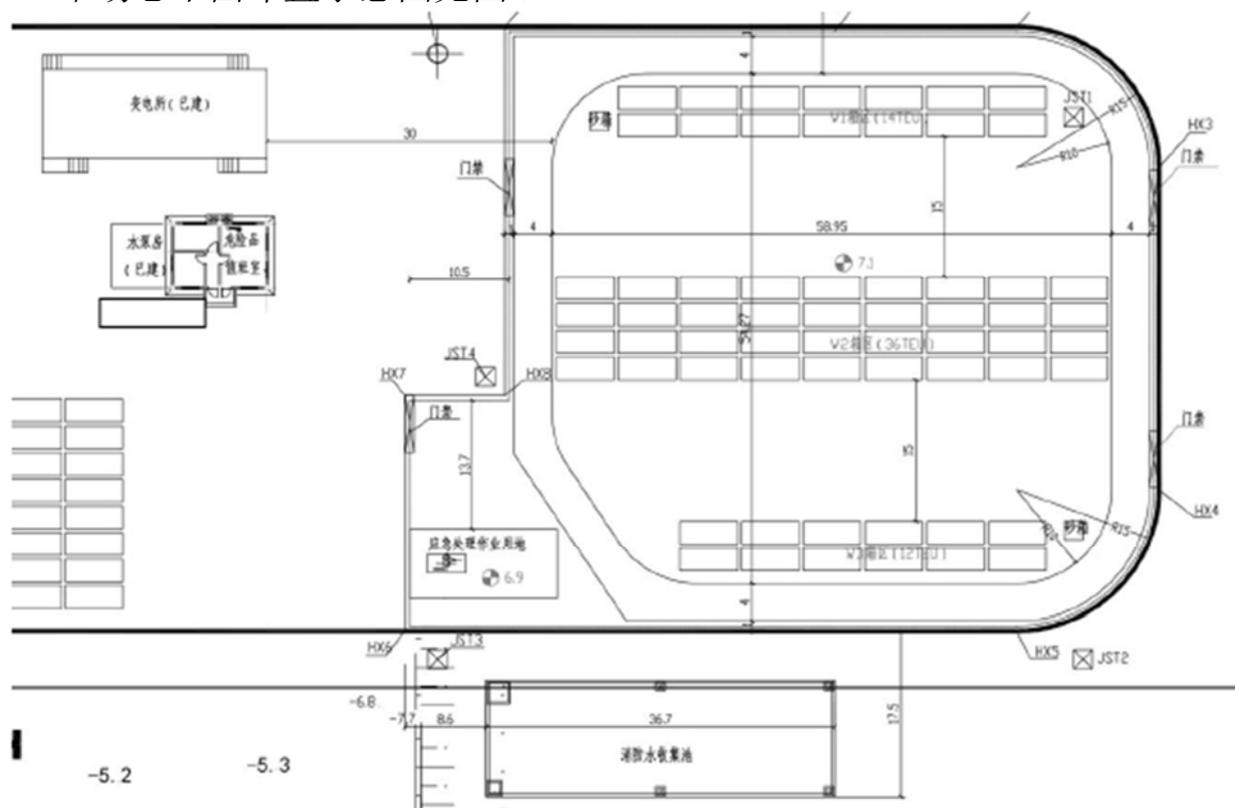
危险货物集装箱堆场总平面布置示意图
